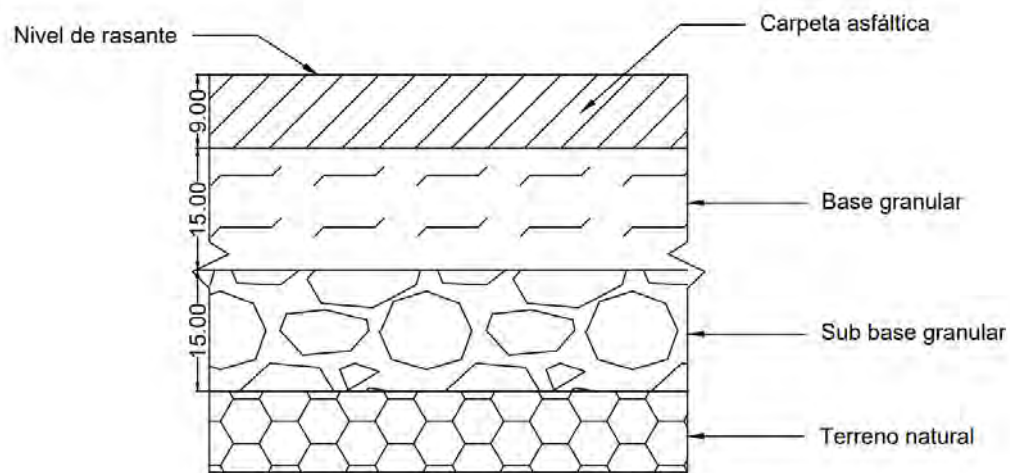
Detalle del diseño del pavimento flexible para 10 años
